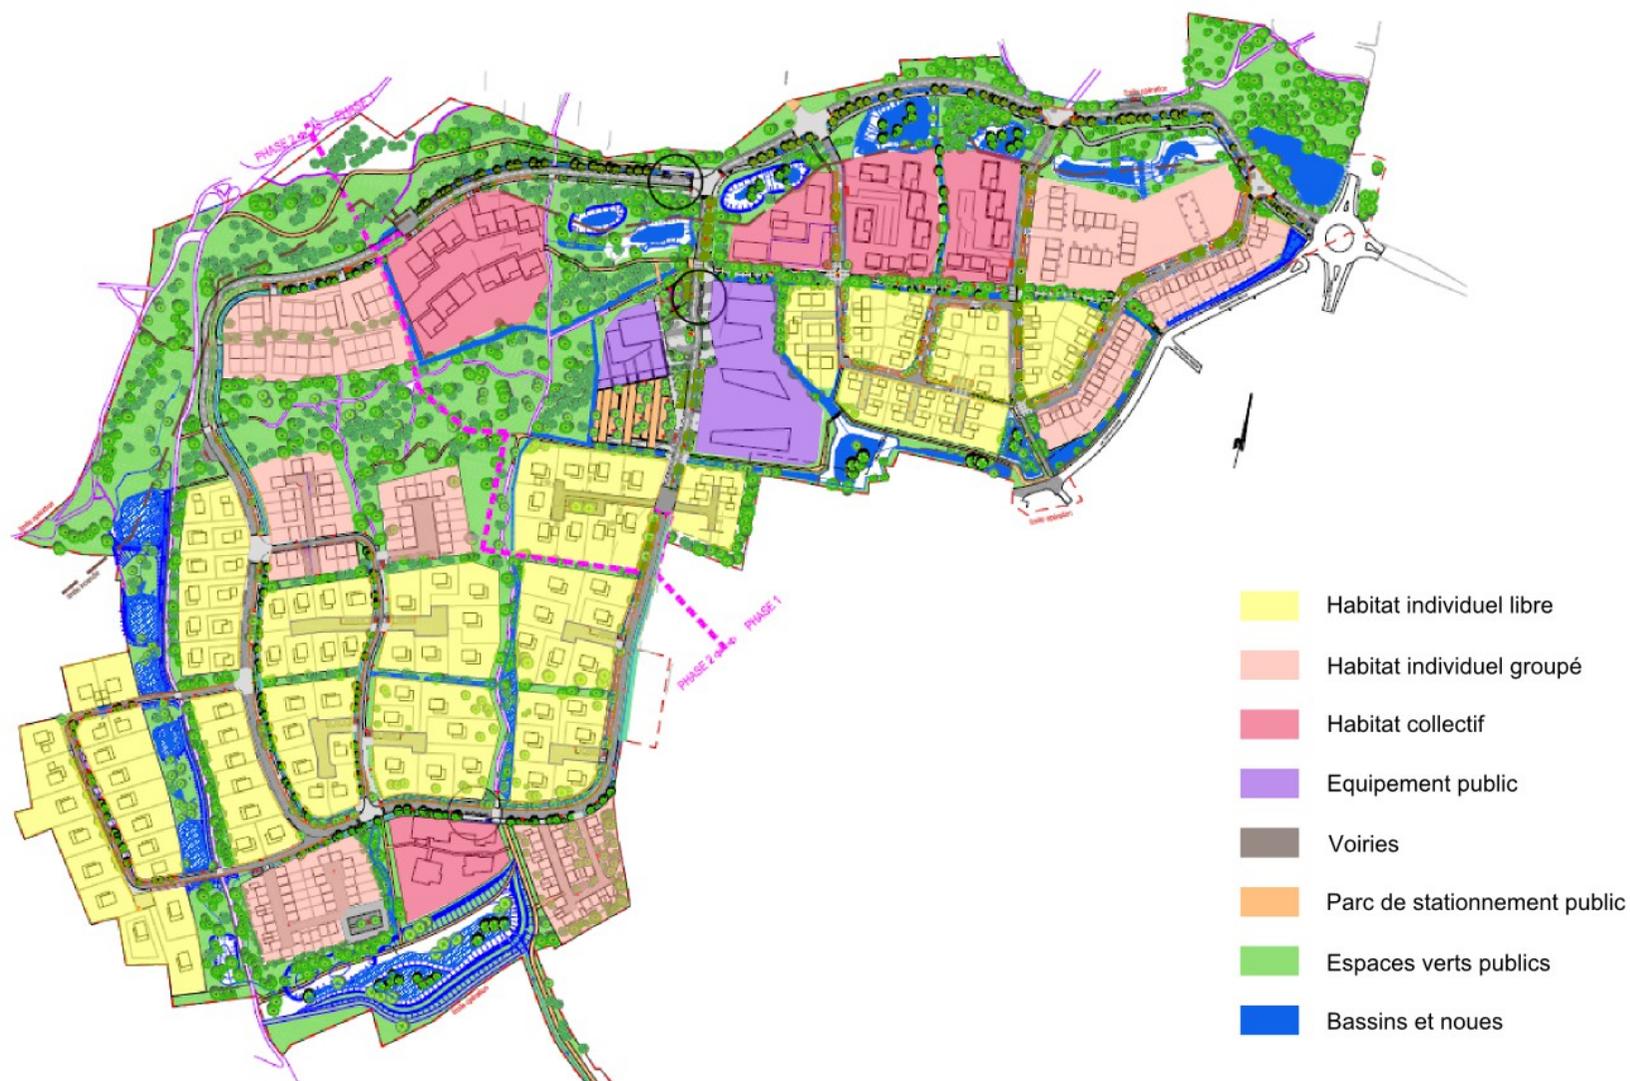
Plan masse au stade actualisation du dossier de réalisation - février 2014 (source Atelier LD, 2014)
